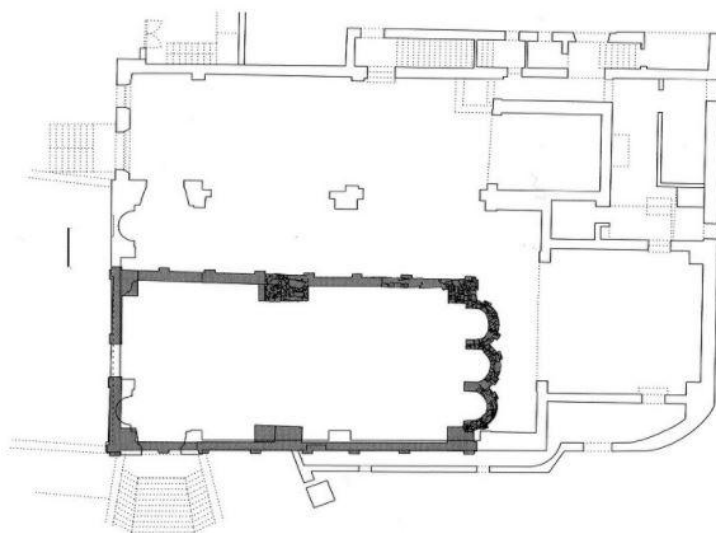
Pianta edificio della seconda fase (anteriore al XI sec.).
